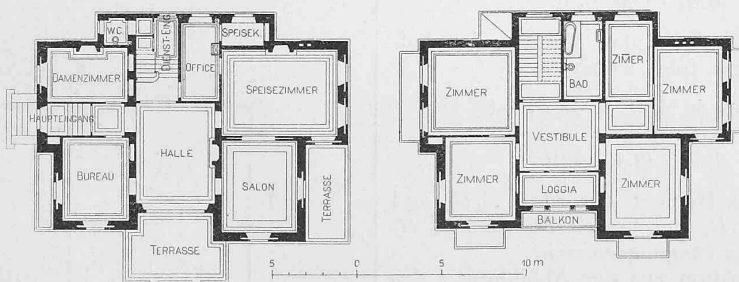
Grundrisse der Villa Manzoni in Lugano.
